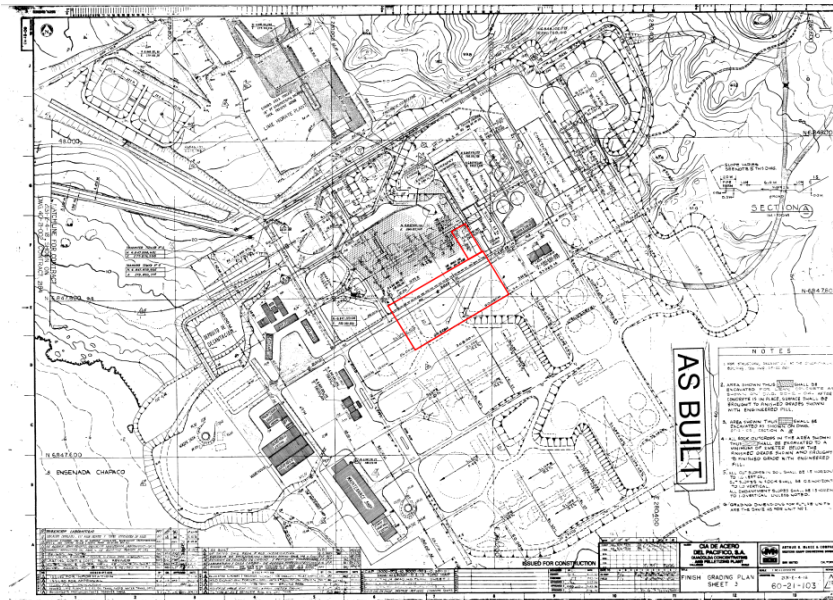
4: Lay out de las dependencias de Planta de Pellets CAP S.A
